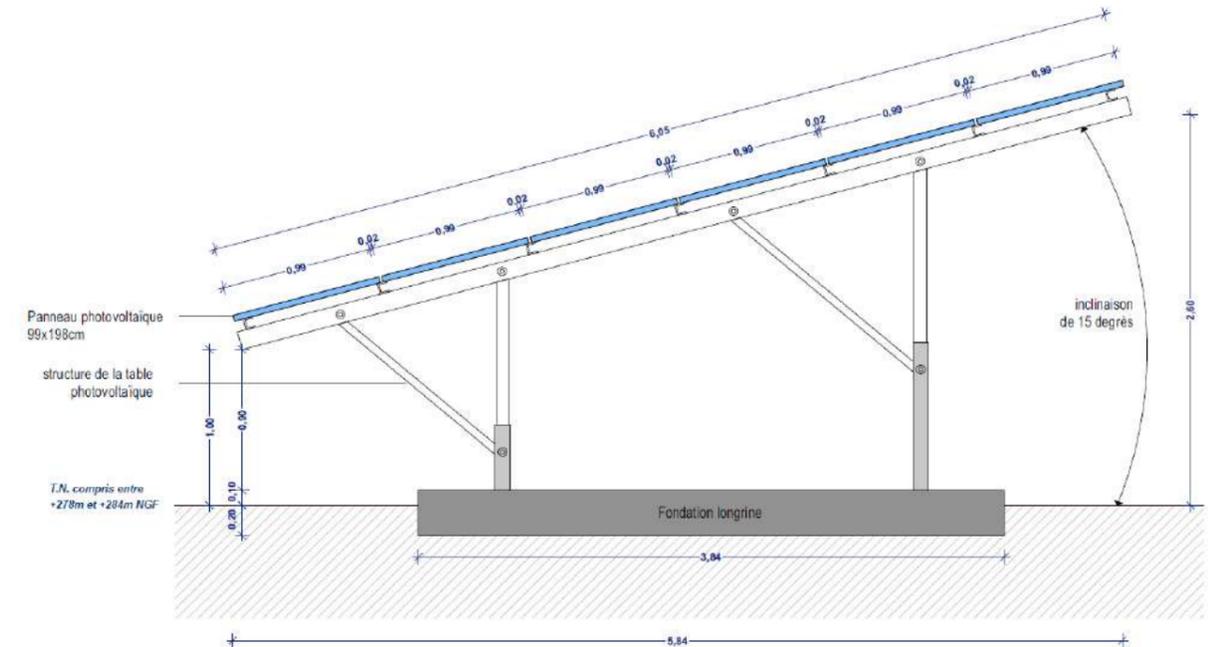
Exemple d'une coupe schématique d'une structure photovoltaïque – Fondation par longrine (Source : EDF Renouvelables)
